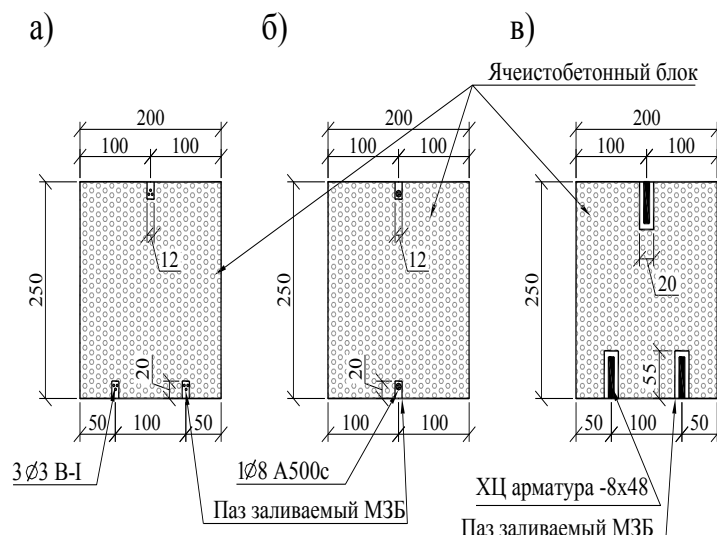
Поперечное сечение перемычек с проволочной ПСБ-1 (а), стержневой ПСБ-2 (б) и асбестоцементной ПСБ-3 (в) арматурой
